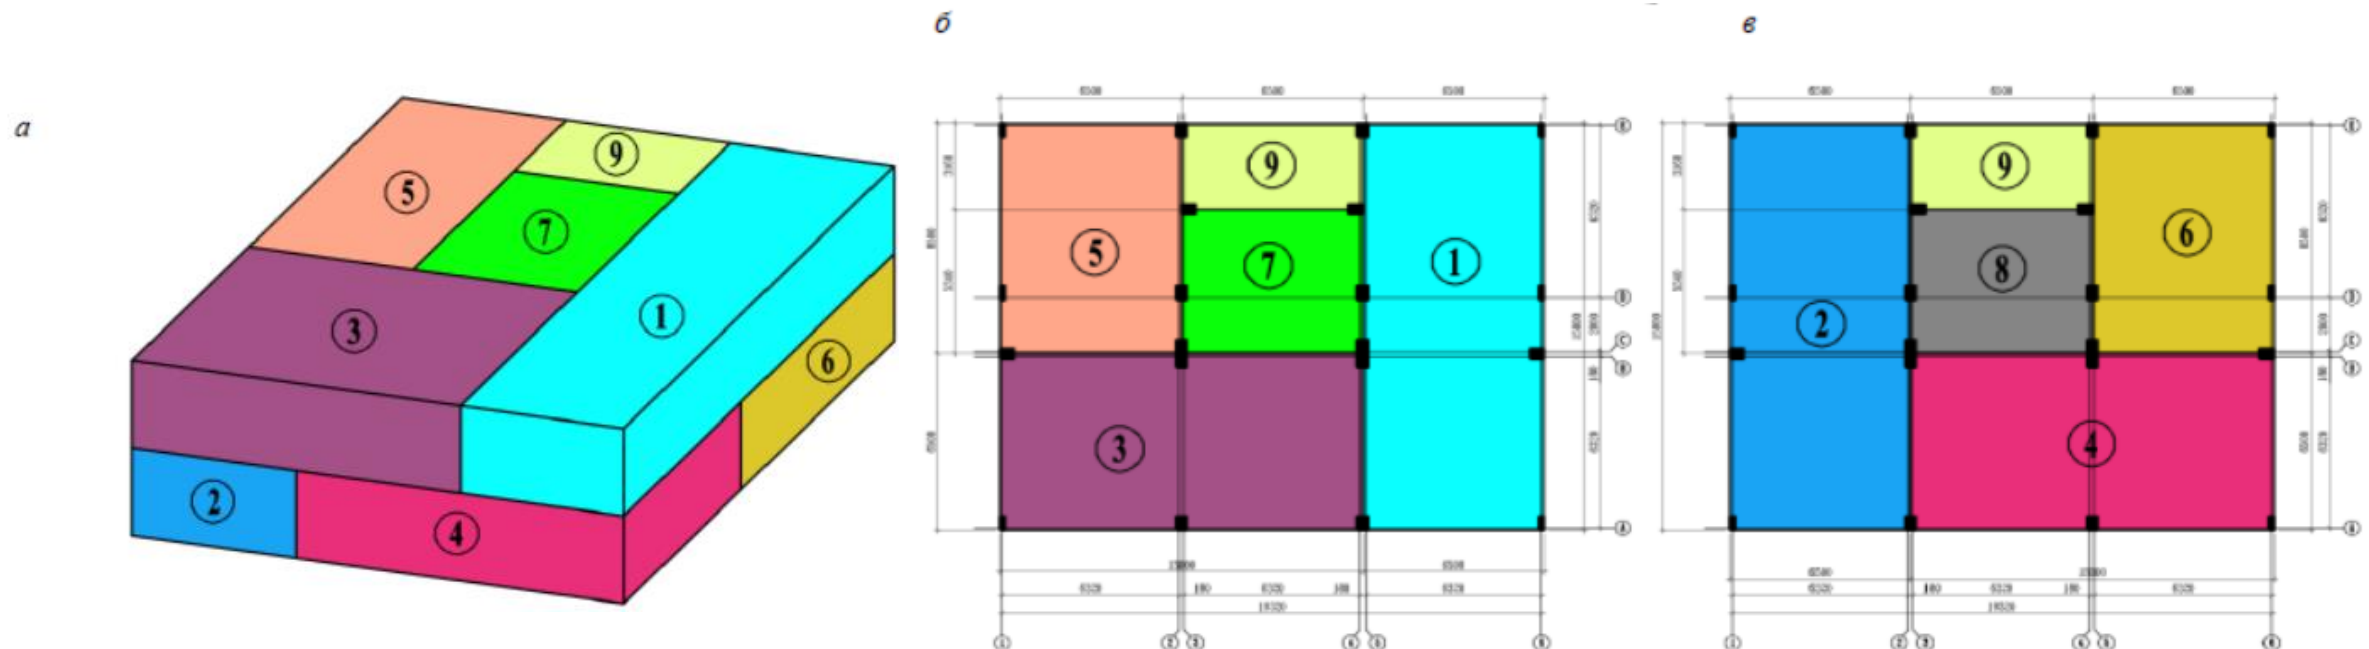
Приклад схеми збирання будівлі із блоків:
